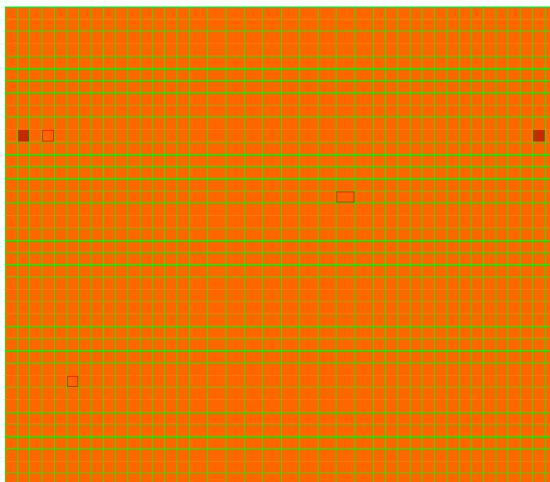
Армирования нижней зоны вдоль буквенных осей (см²)
